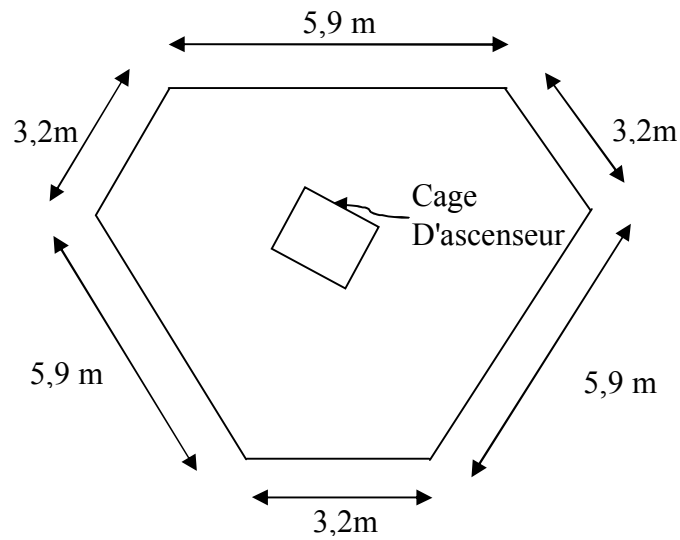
Dalle au niveau du R.D.C et de l'étage courant
